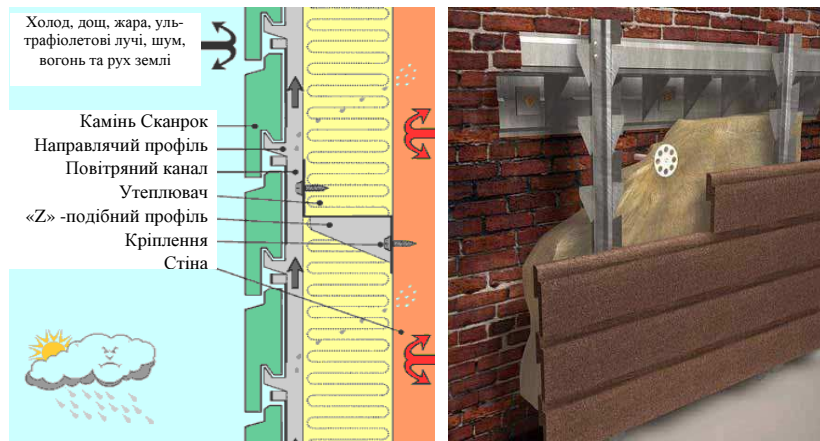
Схема вентилязованого фасаду СКАНРОК
